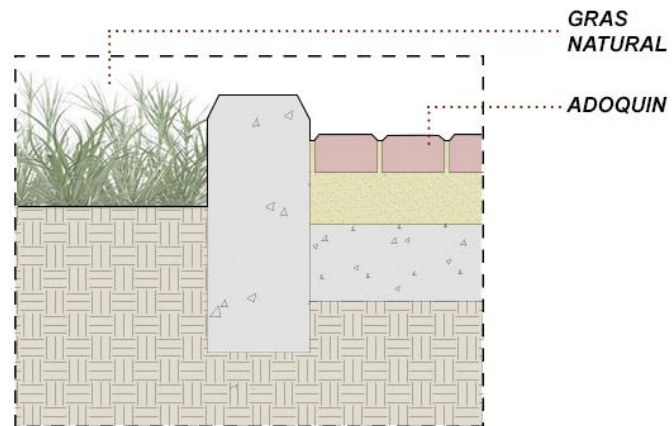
Tipos de pavimentos en el espacio público. Fuente: Elaboración Propia.
